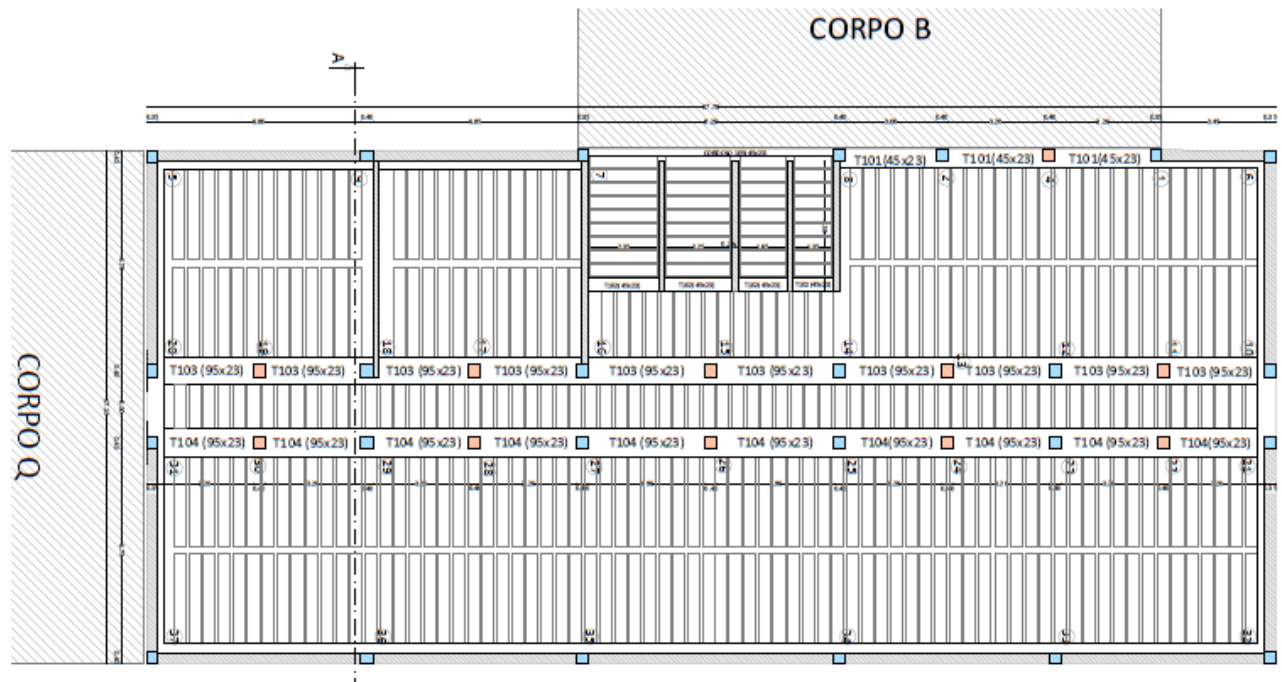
Blocco A - Planimetria Struttura del Piano Terra.
